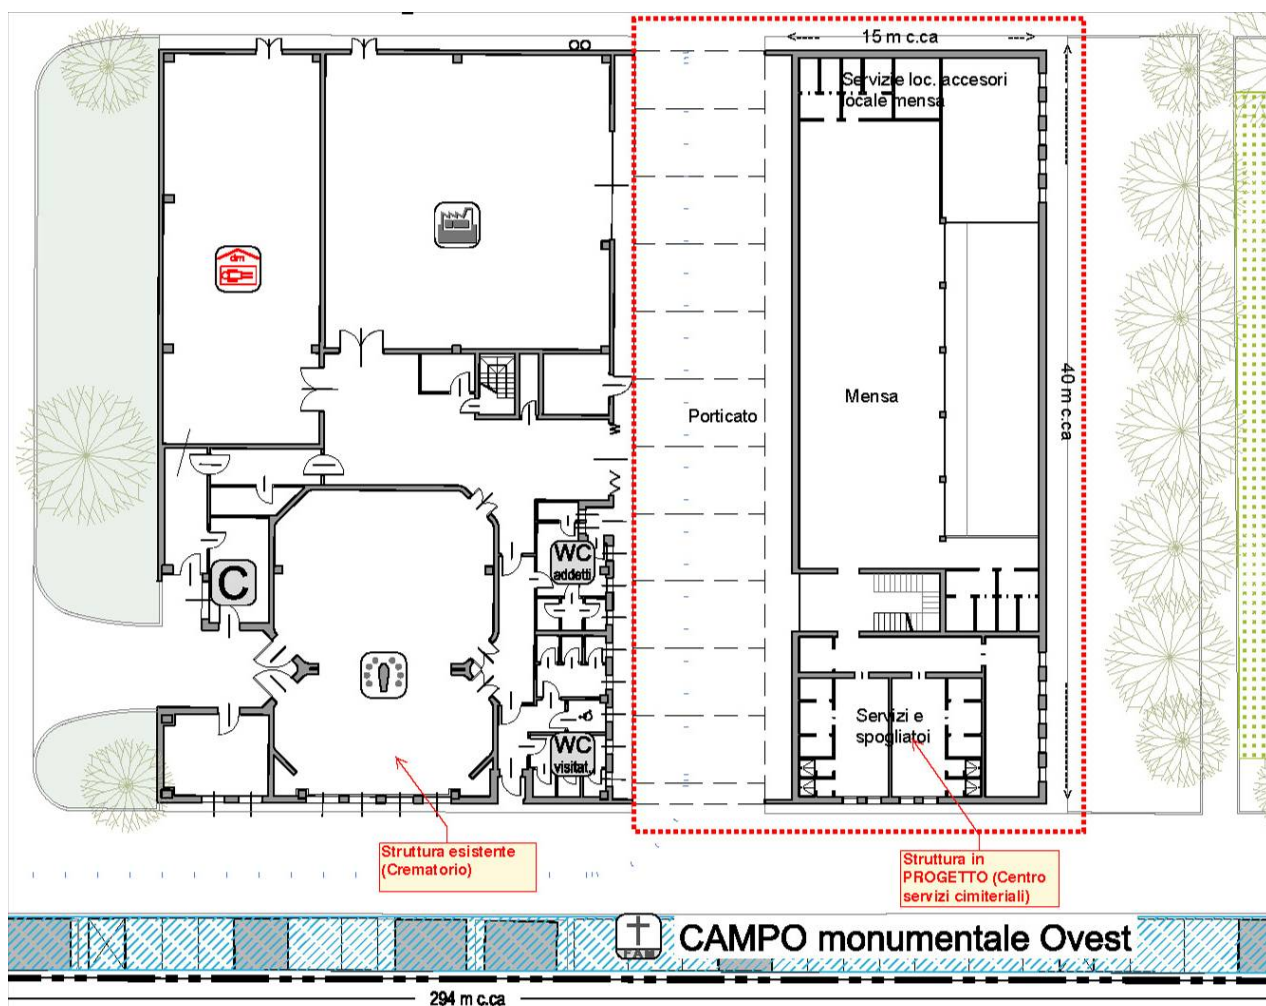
Planimetria dello schema progettuale elaborato dal Piano.
